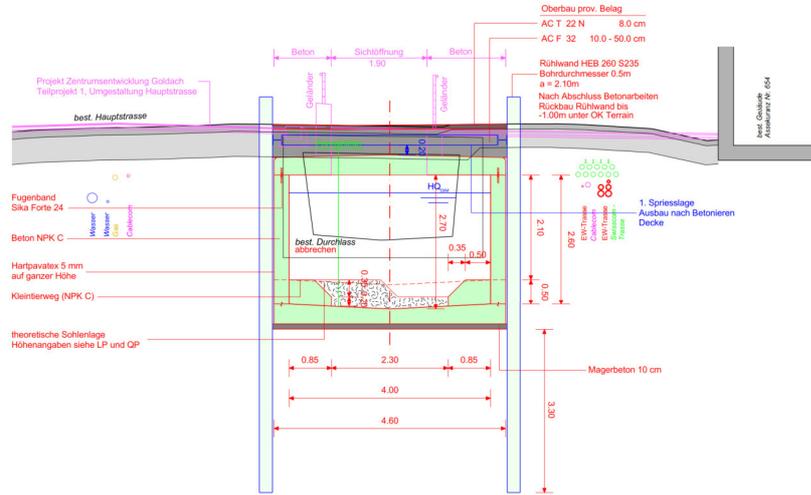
Normalprofil 2, Bereich Hauptstrasse (Sichtöffnung, Ortsbeton)
